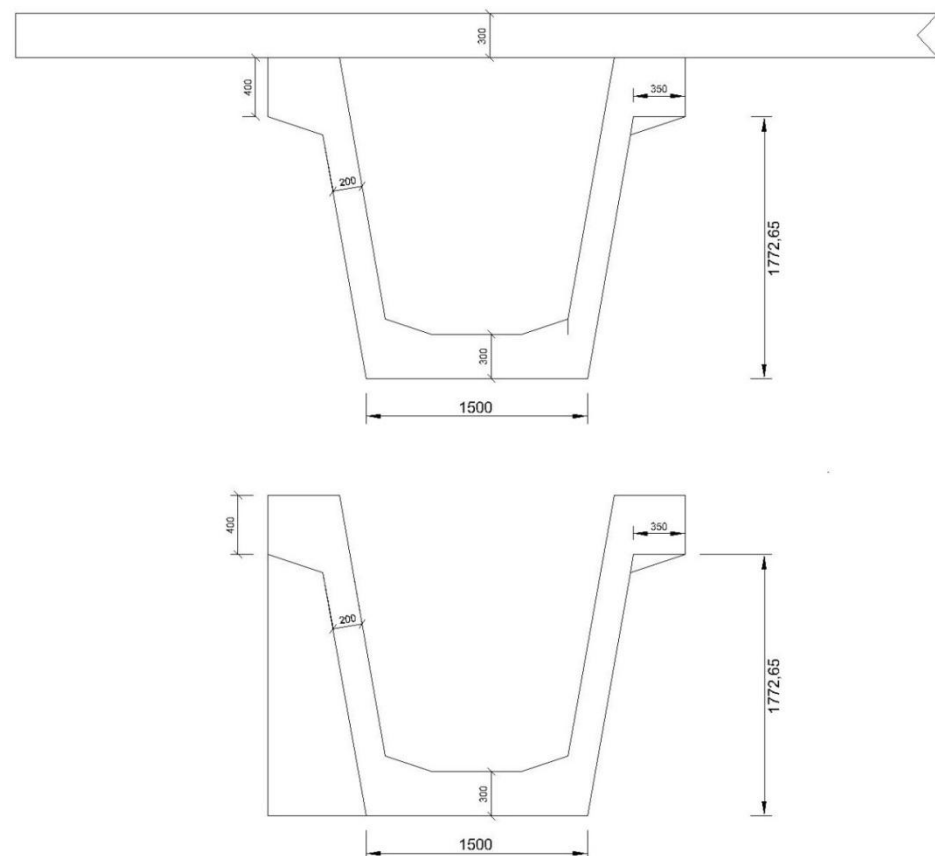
Dimensiones de las vigas longitudinales y del tablero
